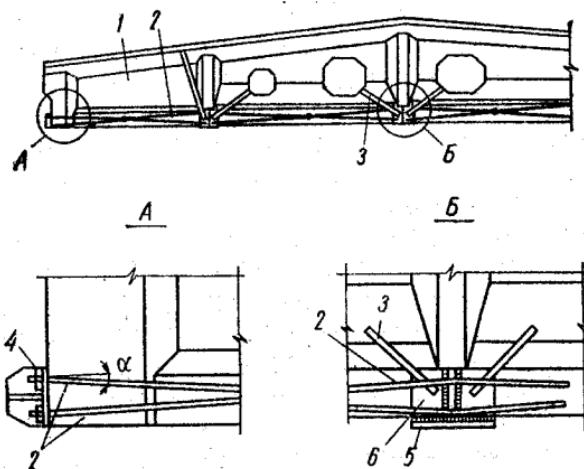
Усиление нижнего пояса стропильной балки горизонтальной предварительно напряженной затяжкой:
